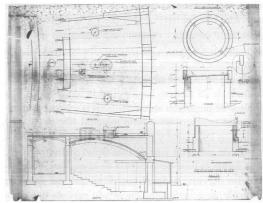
Plano de ejecución donde se muestra la sección y planta de las aulas teóricas y el corredor de acceso a las mismas (Archivo personal de Vittorio Garatti)
